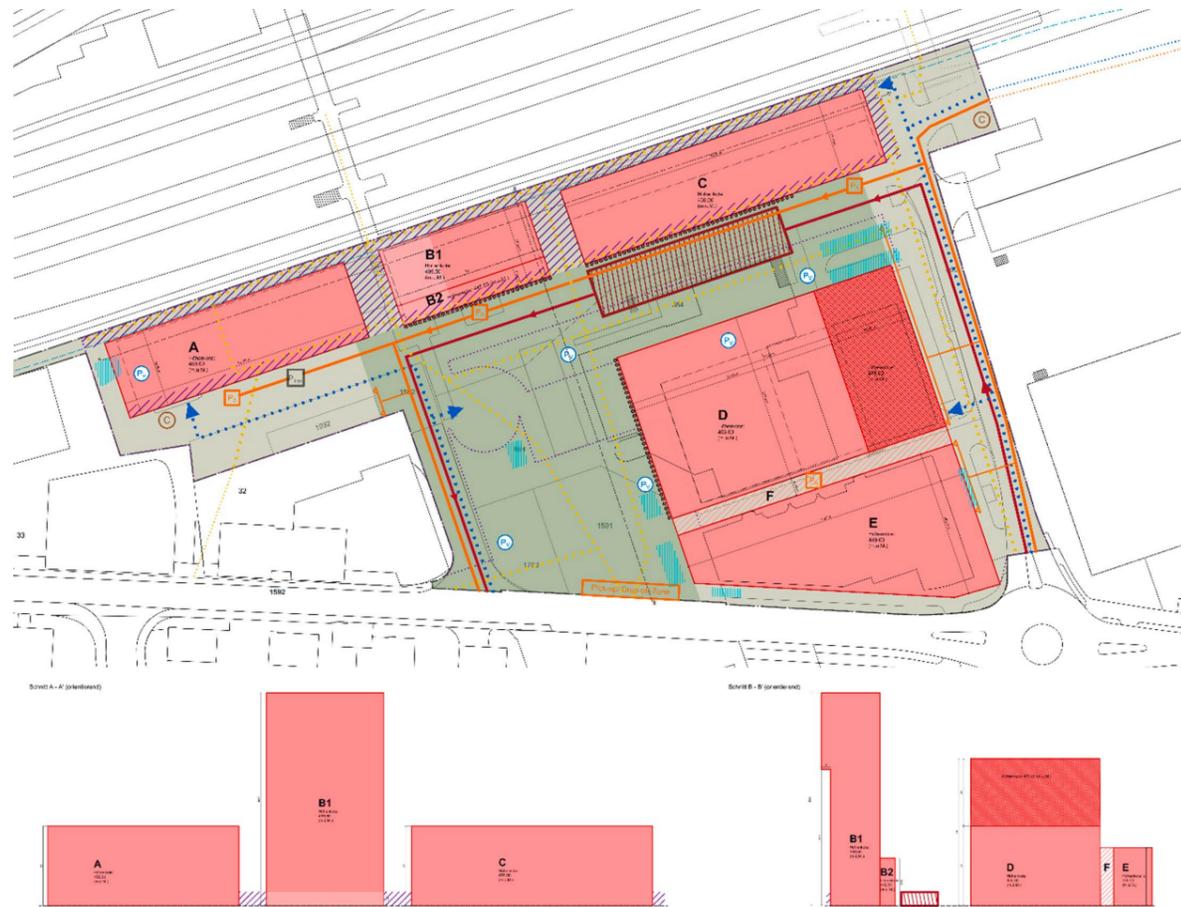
Bebauungsplan Bahnhof Süd, Baufelder der SBB: A, B1/B2 und C (Quelle: Genehmigter Bebauungsplan).
